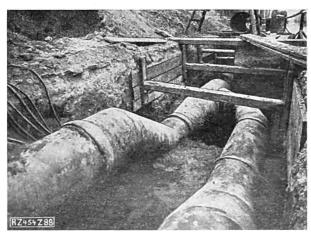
Muffenkehlschweißung für Wasserleitungsröhren von 600 mm l. W.
